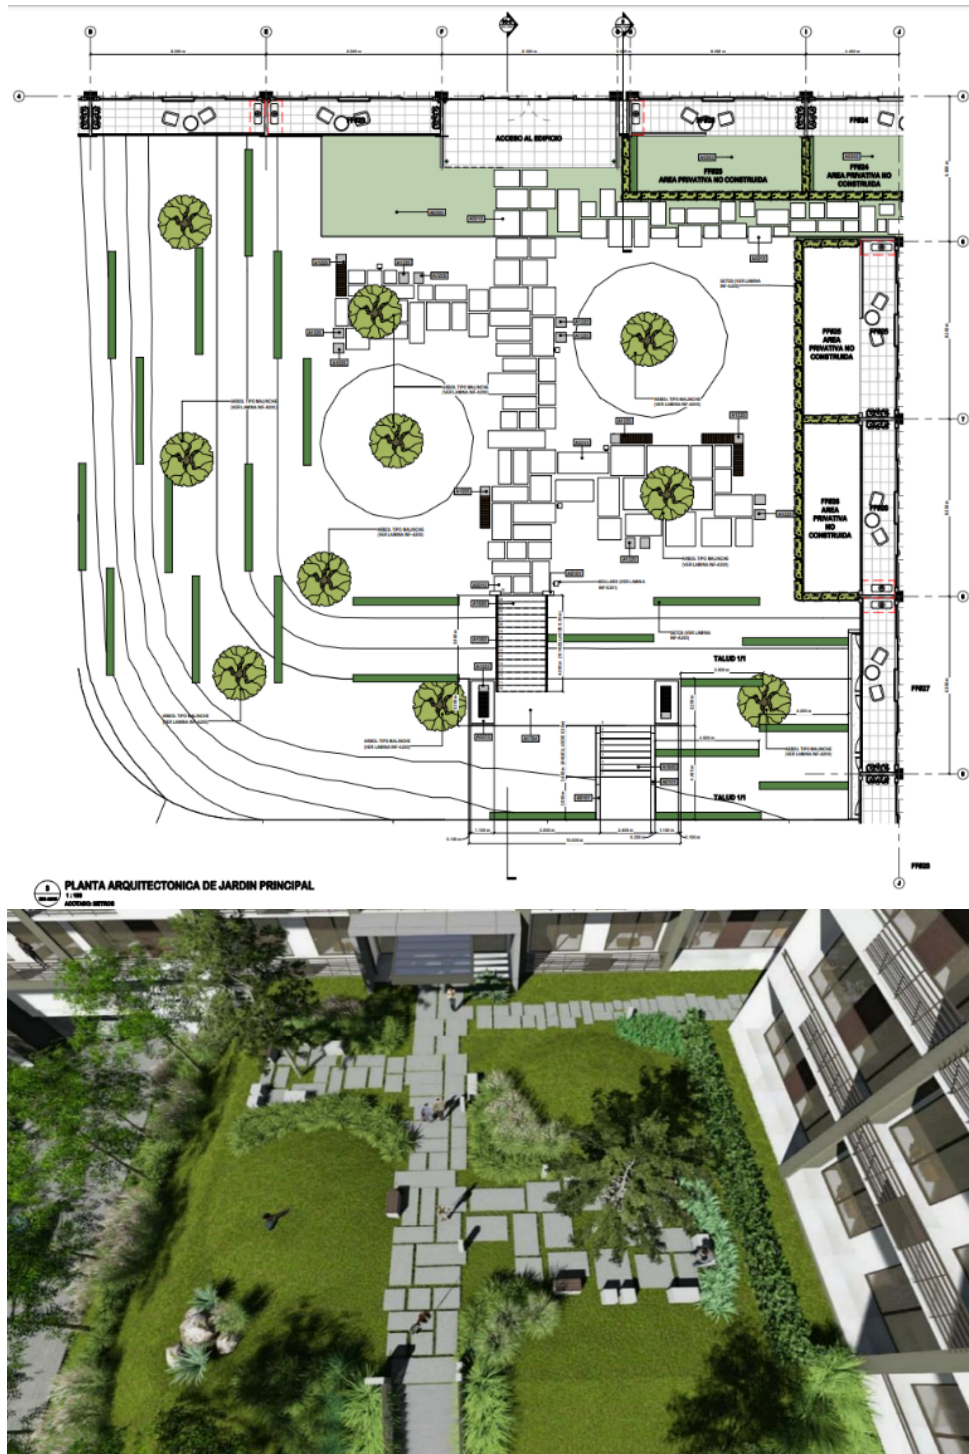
Planta arquitectónica y render de jardín principal. Fuente: Proyecto Residencial Condominio Urban Flats
